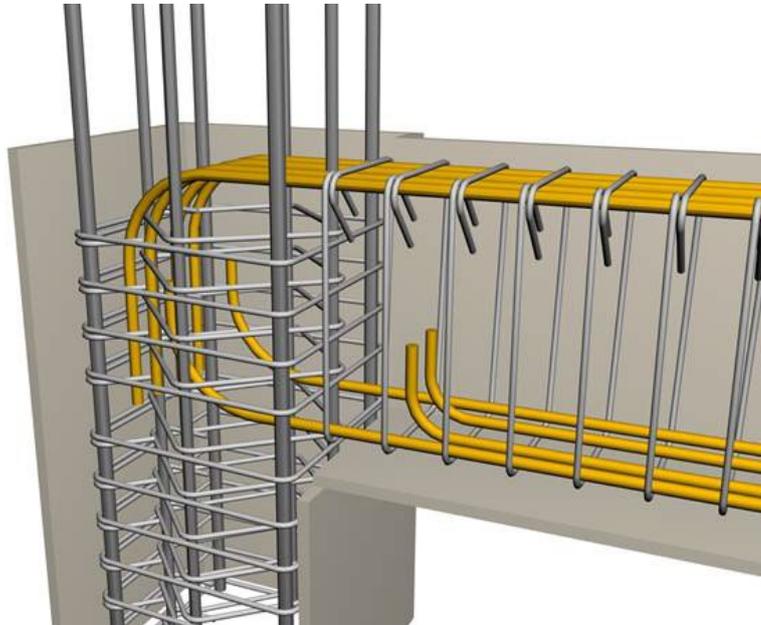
Схема взаємного з'єднання арматури балки і колони
